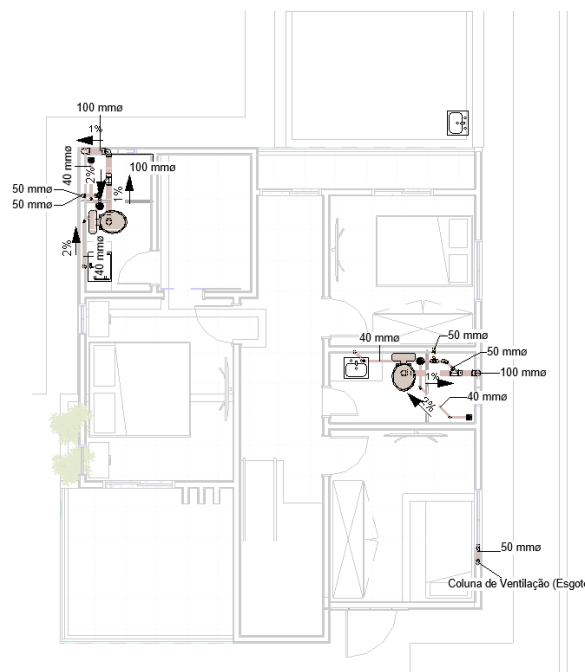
Planta Baixa das Instalações de Esgoto – Pavimento Superior
